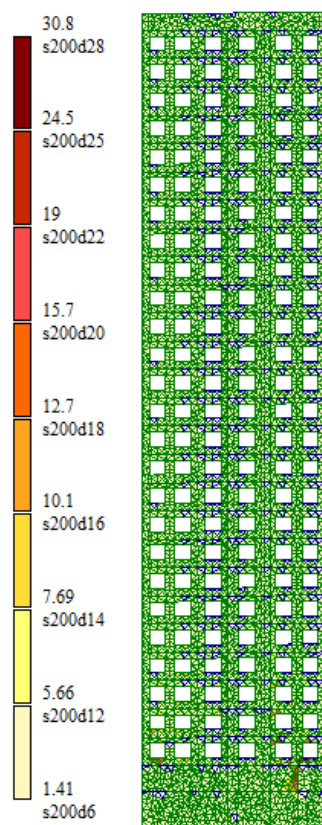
Схема армирования стен по оси X (у верхней грани)
